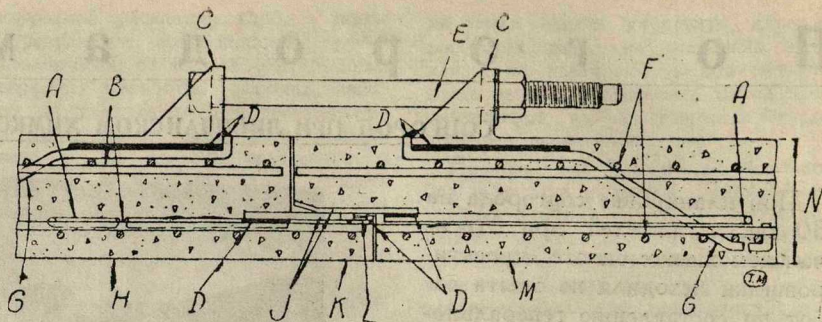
Разрез гибкого соединения труб: А—круглое 12,7 мм железо с крючком на одной стороне, длина 457 мм; В—арматура того же диам.; С—упорная стойка из литой стали, ширина 102 мм; D—сварка; E—стяжной болт 38×635 мм (по две штуки на каждое соединение); F—арматура или проволока № 3; G—якорные тяги 114×12,7×762 мм; H—стычная сторона трубы; J—стальные полосы; K—картон; L—каучуковая прокладка; M—раструбная сторона трубы
